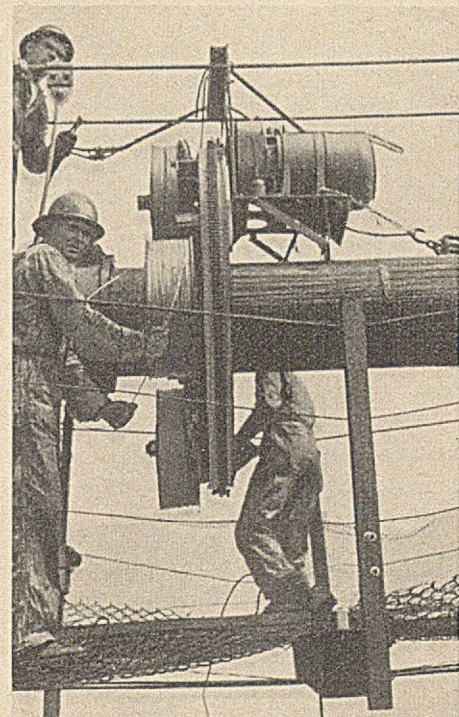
Die fertigen Stränge wurden auf den Hilfsstegen mit Stahlbändern in gleichen Abständen zusammengebunden.
